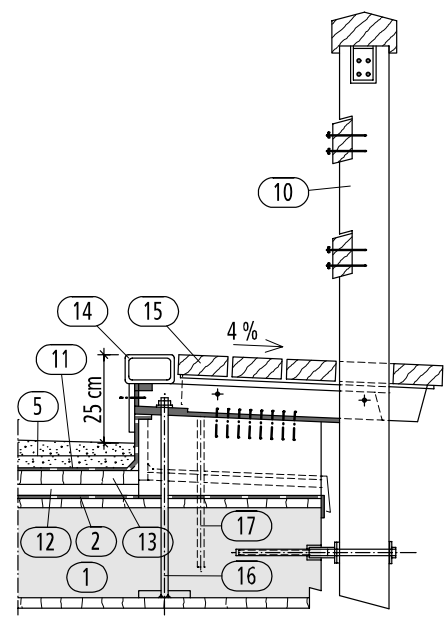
Schrammbordausbildung bei einer SLW 30-Brücke, vgl. auch Bild 6.2; 6.3: Holmgeländer für abgelegene Brücken mit Zustimmung der Bauaufsichtsbehörde möglich
